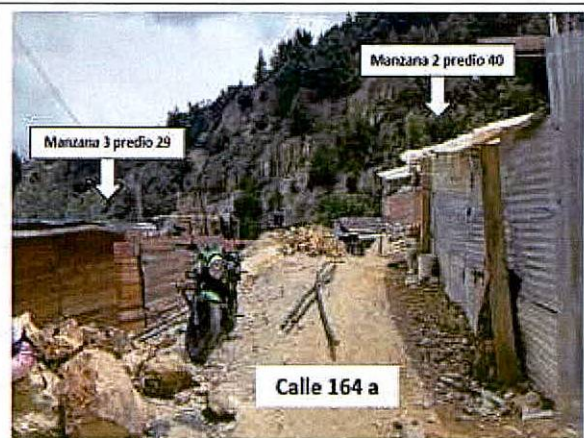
Calle 164 a, esta se encuentra sin pavimentar, además se observan escombros
